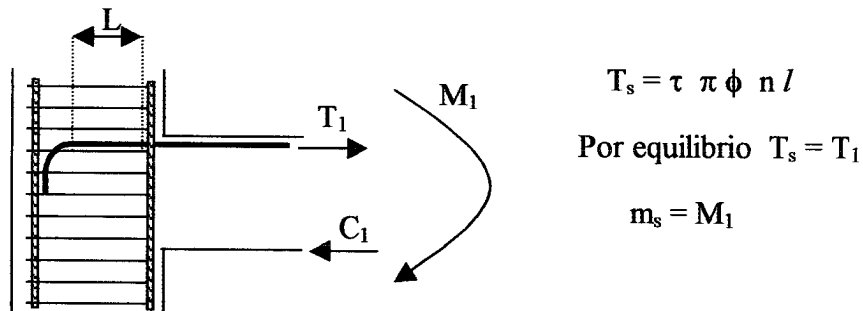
Longitud de adherencia en conexiones viga-columna exteriores.
